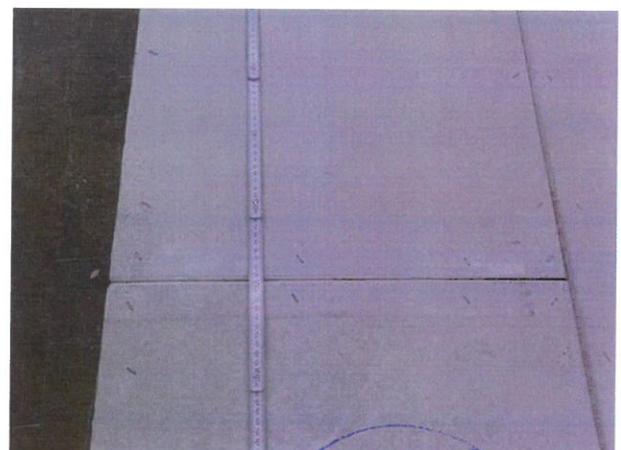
Horizontalstoß der Feuerschutzplatten.
